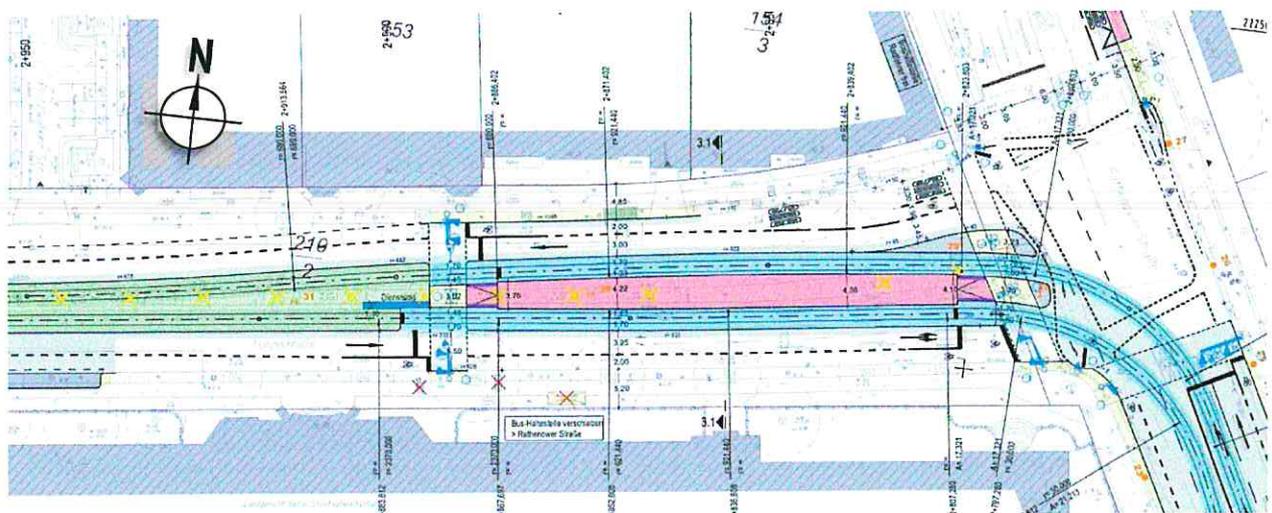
Lageplan Turmstraße, Haltestelle Kriminalgericht Moabit
